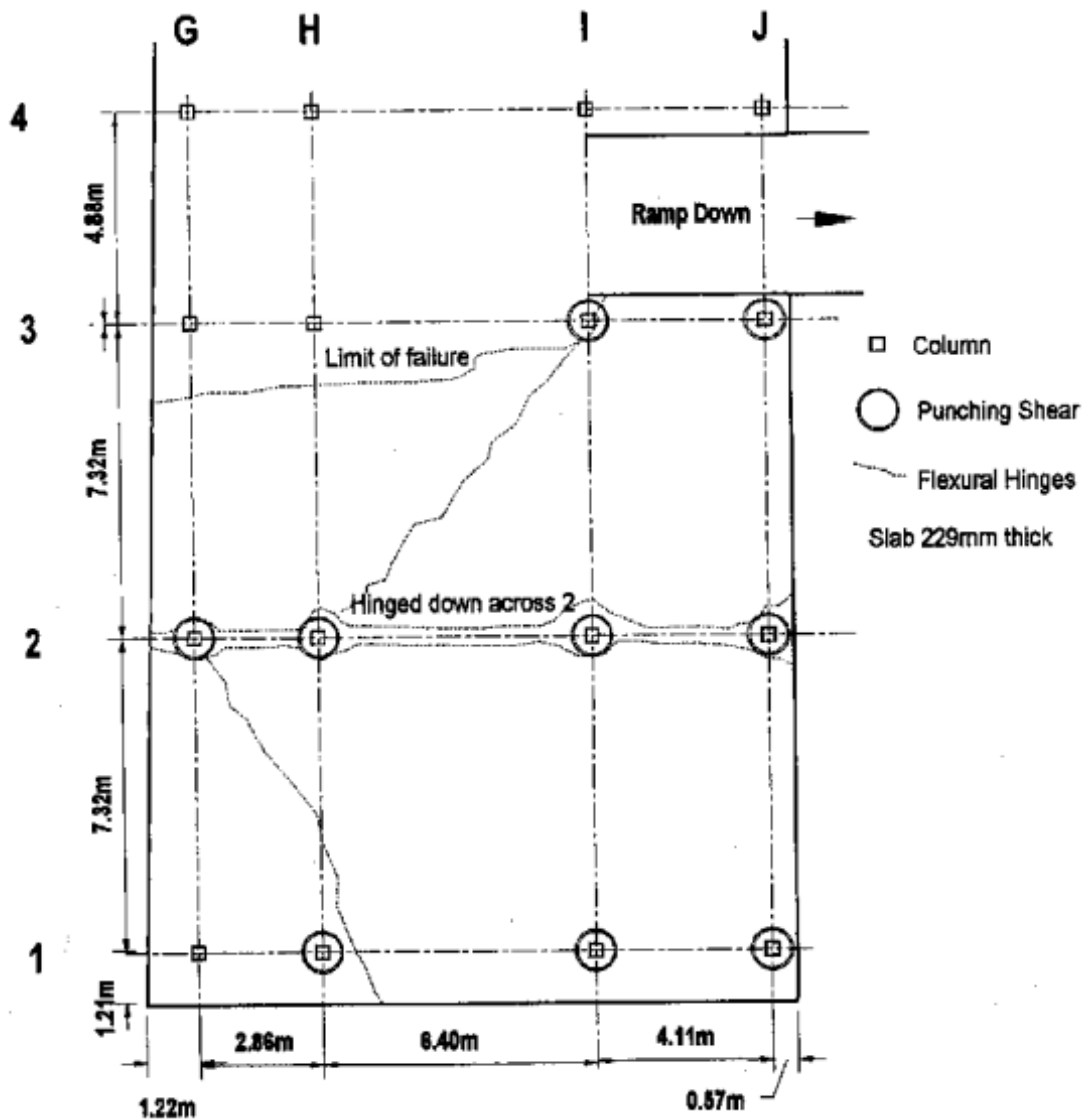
Layout do pavimento do quarto andar (Wood, 2002, p. 31)
